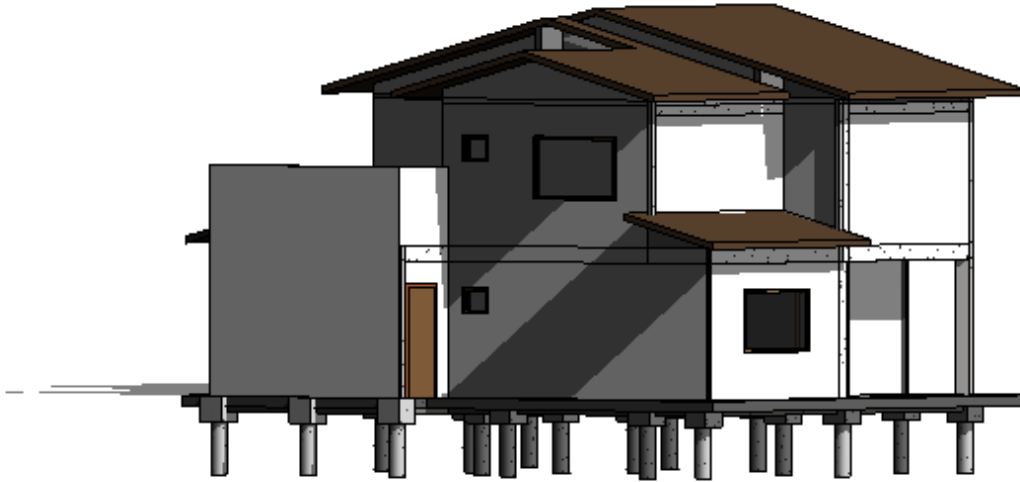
Detalhes do projeto arquitetônico e estrutural acoplados
